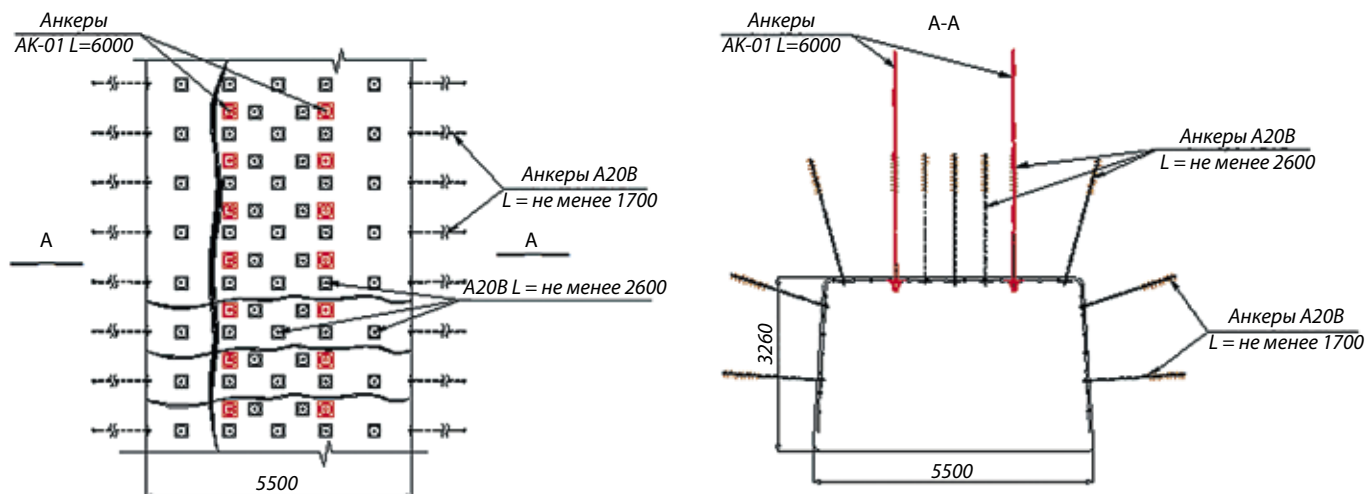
Схема крепления вентиляционного штрека № 26-52
